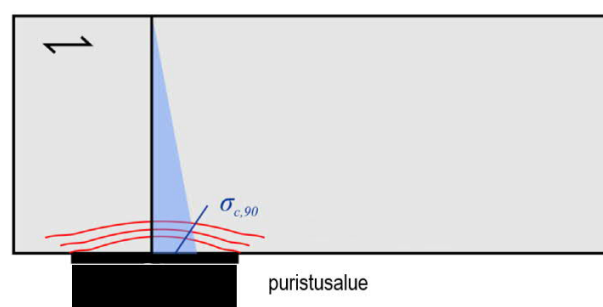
Jännitysten jakautuminen taivutetussa palkissa puun syiden suunnassa (S. Franke et al. / Failure modes and reinforcement techniques for timber, 2015)
